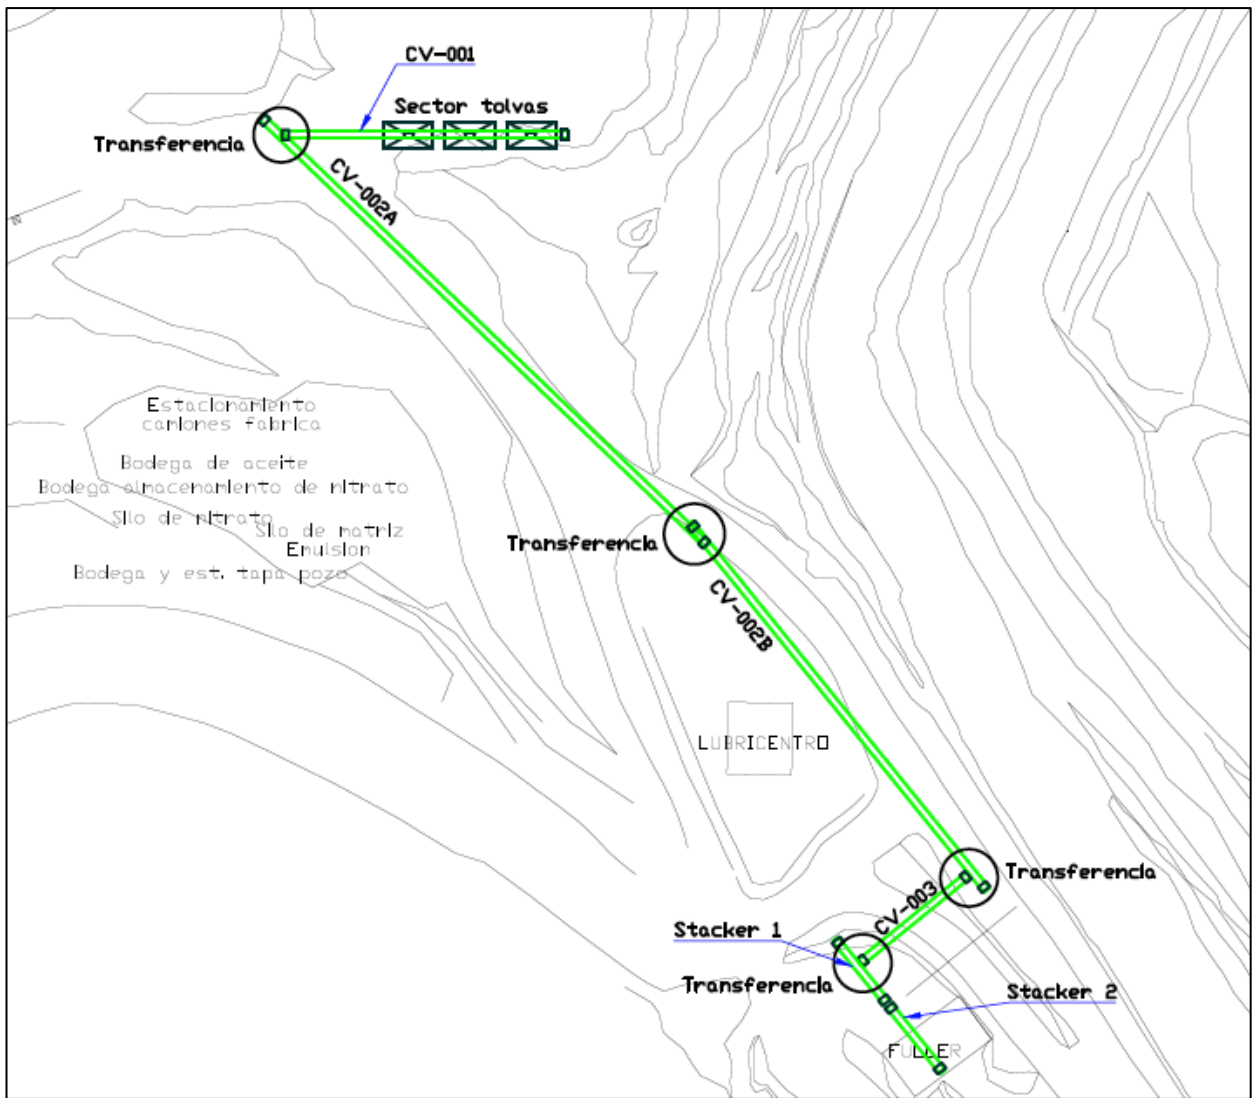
Vista en planta sistema de correas Trazado 2.
